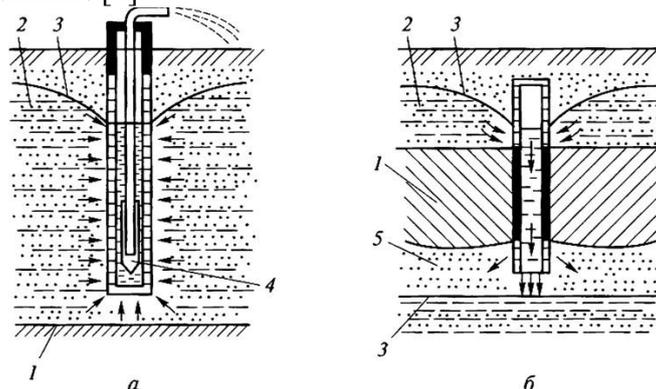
Схема работы дренажных колодцев вертикального дренажа
